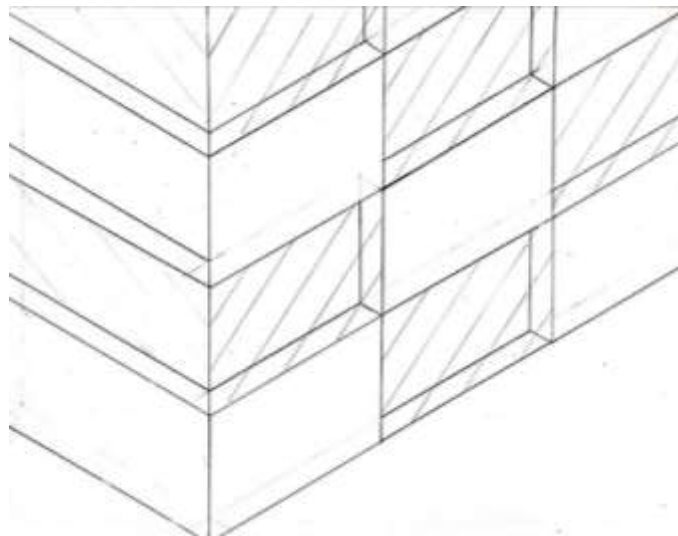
Boceto de fachada rectangular con volumen. Fuente: Elaboración propia.
